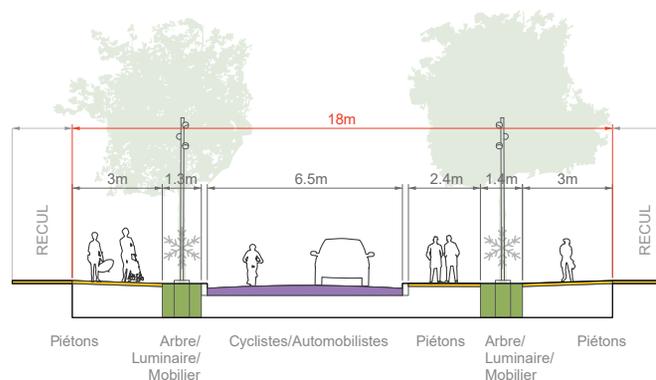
| Rue locale B (18 m) (aucun stationnement dans la rue)
